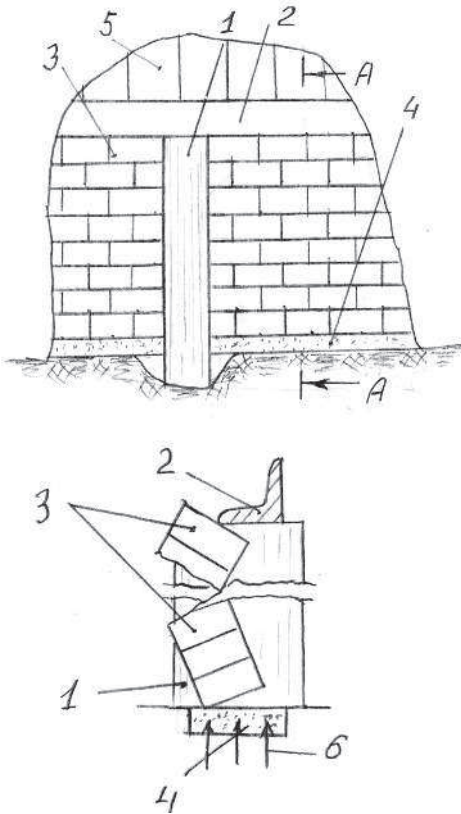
Схема разрушения забирки: 1 — столб фундамента; 2 — нижняя связь металлоконструкций каркаса; 3 — кирпичная кладка; 4 — песчаная подсыпка под забирку; 5 — отделка стен дачи; 6 — силы пучения
